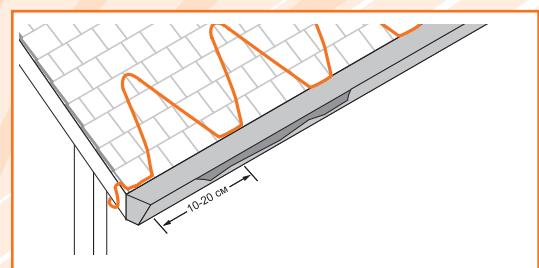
Укладка резистивного кабеля CEILHIT на “мягкой” кровле
